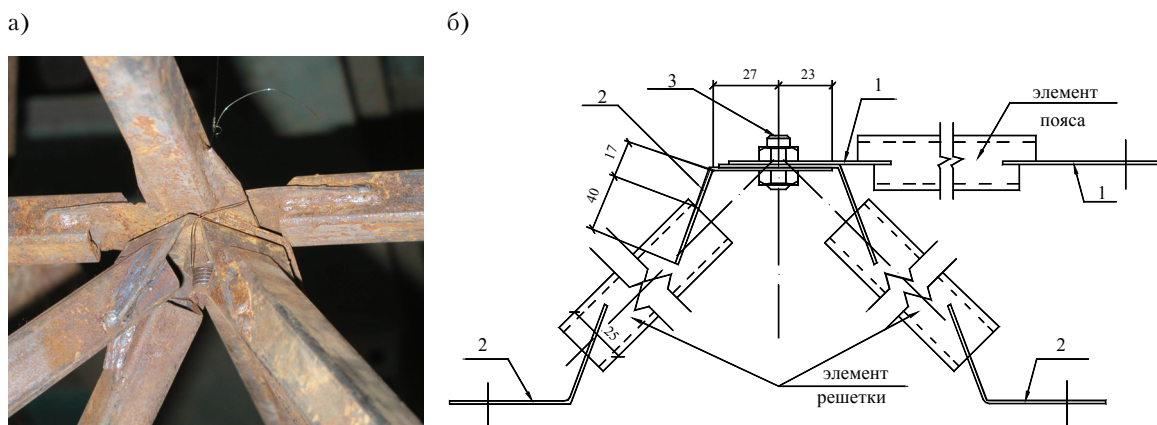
Узел сопряжения элементов структуры «ИНЕКО»: а) узел по верхним поясам структуры; б) схема узла: 1 – горизонтальная узловая фасонка поясного элемента; 2 – гнутая узловая фасонка элемента решетки; 3 – вертикальный узловой болт.
